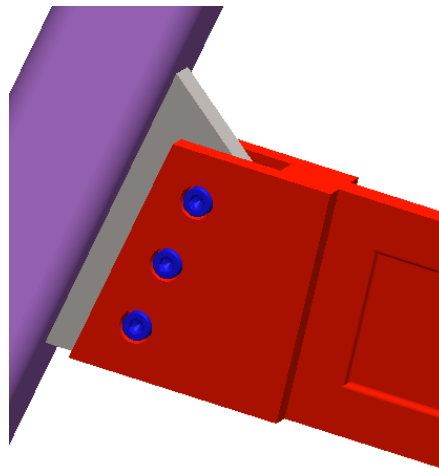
Vista de montaje de pieza N°10 con pieza N°2 (Fuente 99)
